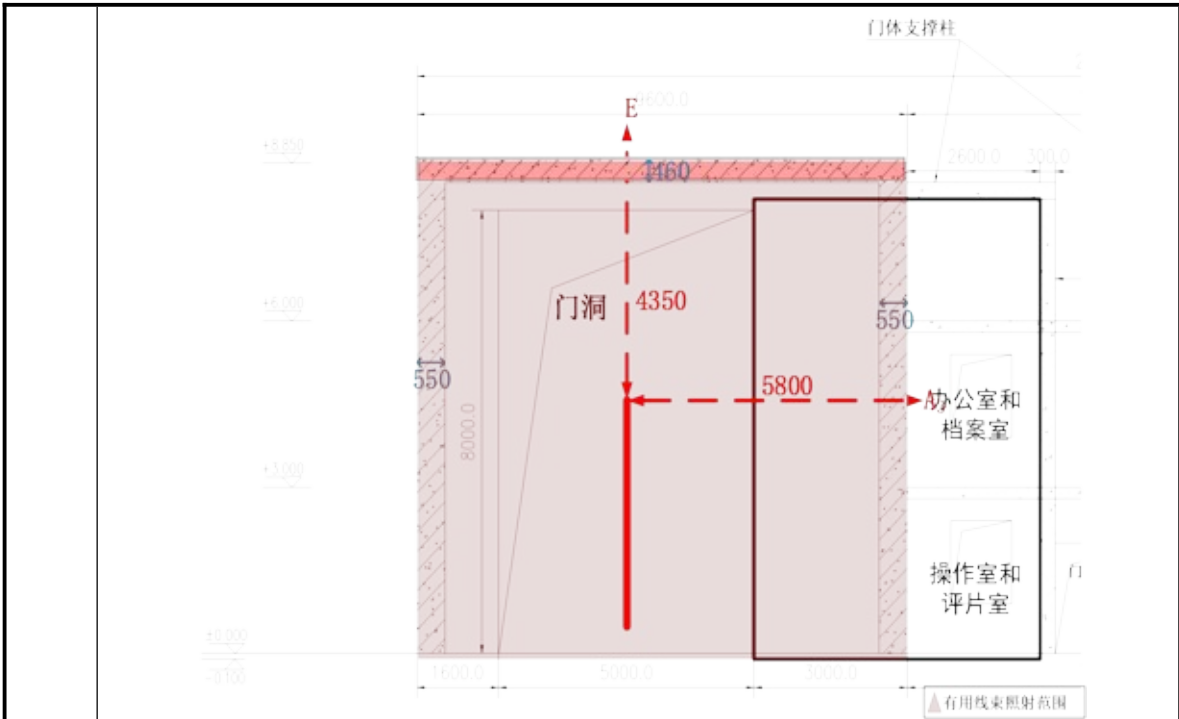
周向探伤机关注点位示意图（剖面图 1，单位：mm）
